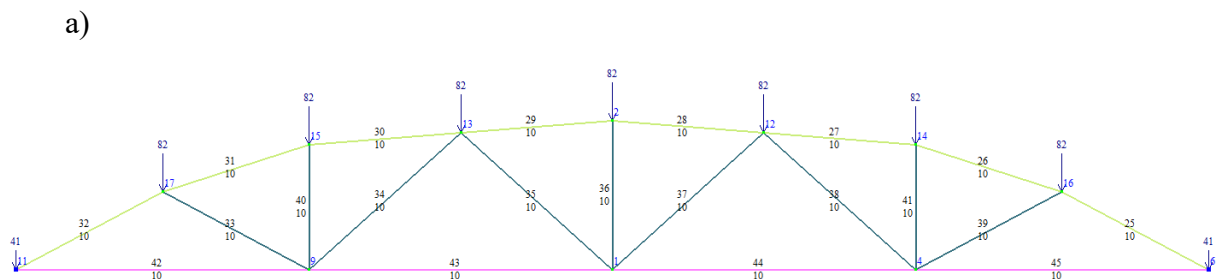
а) Розрахункова схема навантаження від власної ваги ферми Ф-1;
